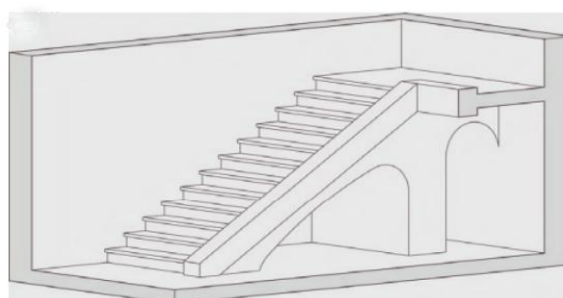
escalier droit sur voûte en berceau rampant. [39]
